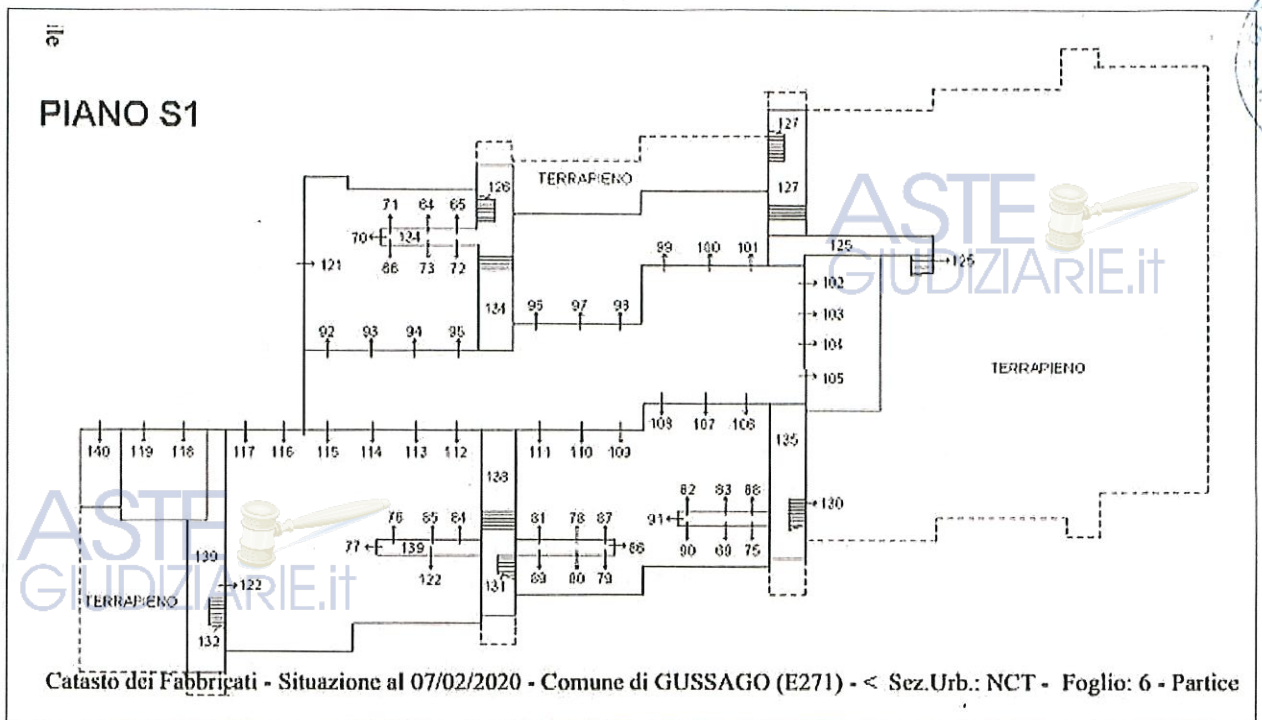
Estratto elaborato planimetrico catastale – piano interrato
